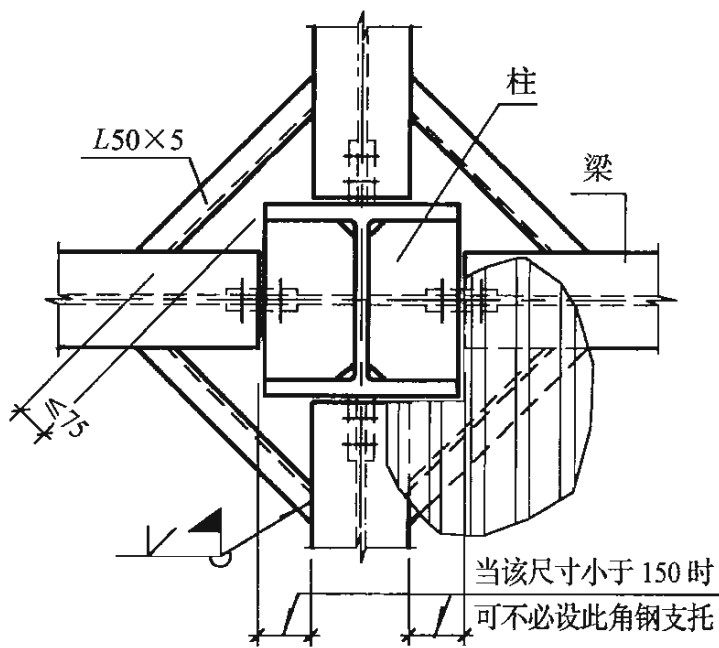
柱与梁交接处的压型钢板支托示意图
